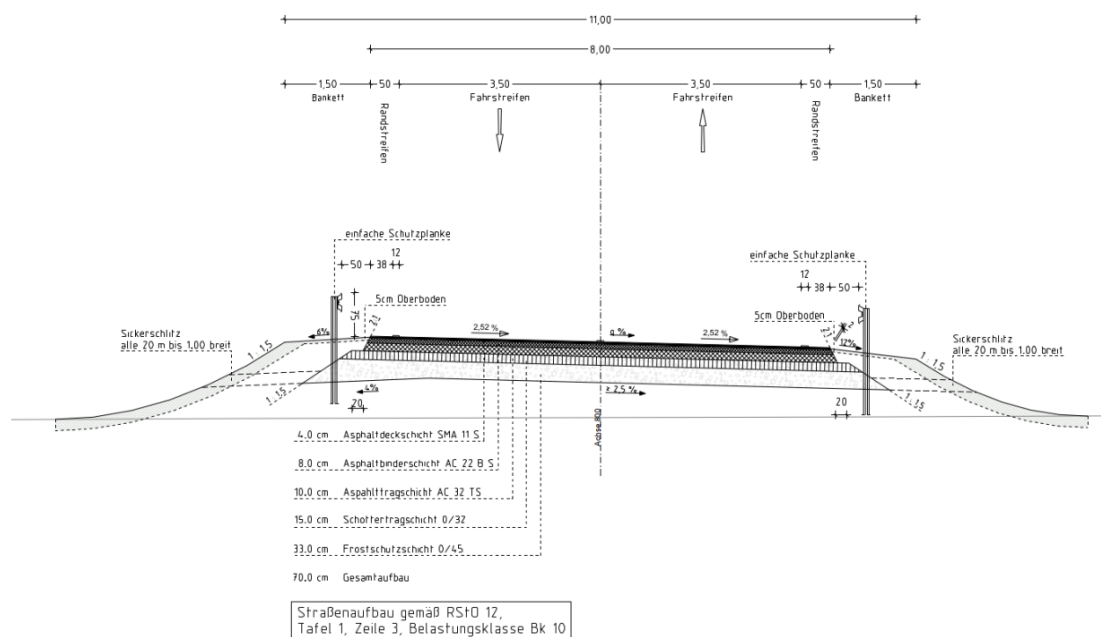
Straßenaufbau mit Regelquerschnitt L78b (MAILÄNDER CONSULT 2020).
